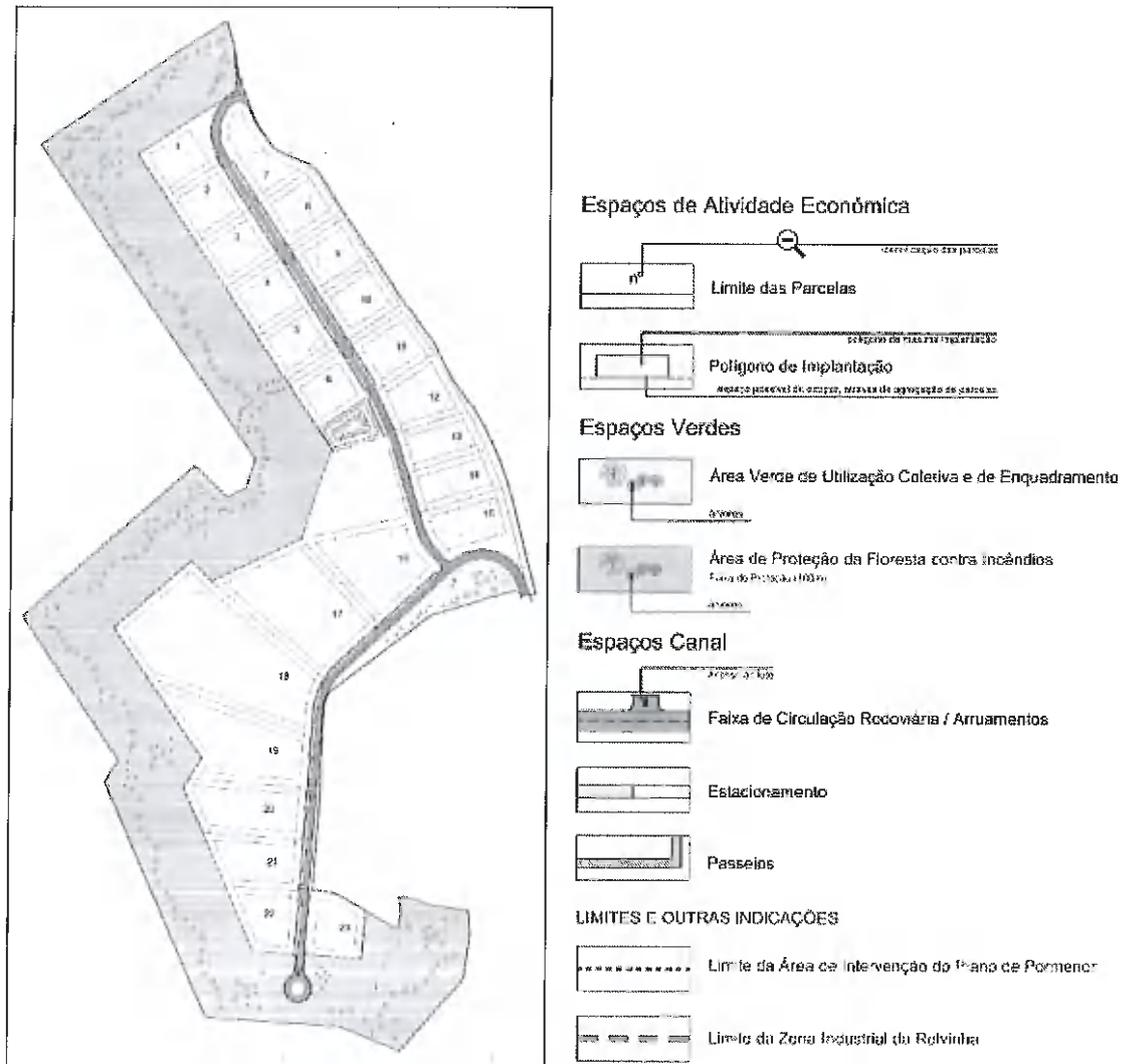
Planta de implantação do PP da Zona Industrial da Relvinha
